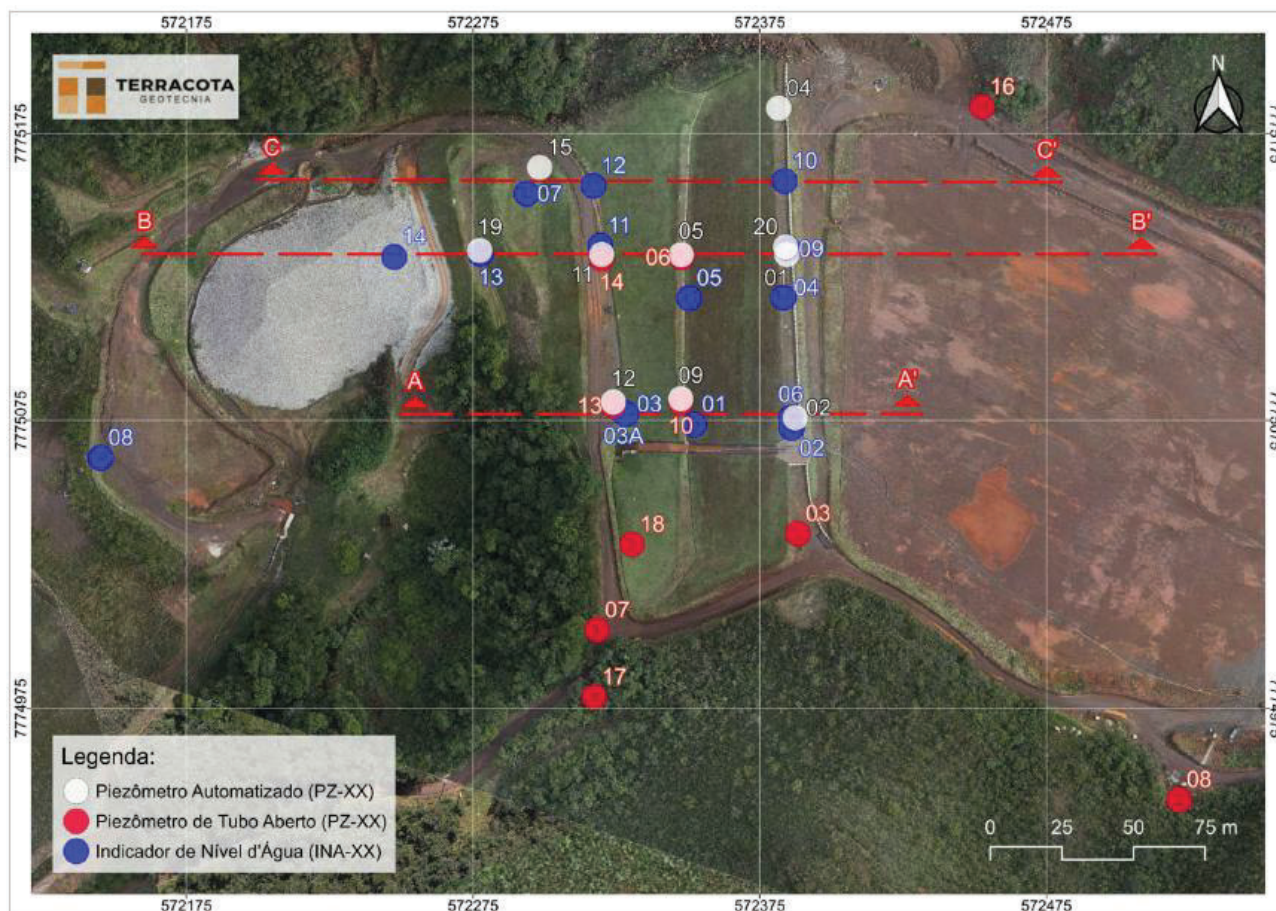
Seções Instrumentadas Barragem B1 – Mina Ipê – Planta.
